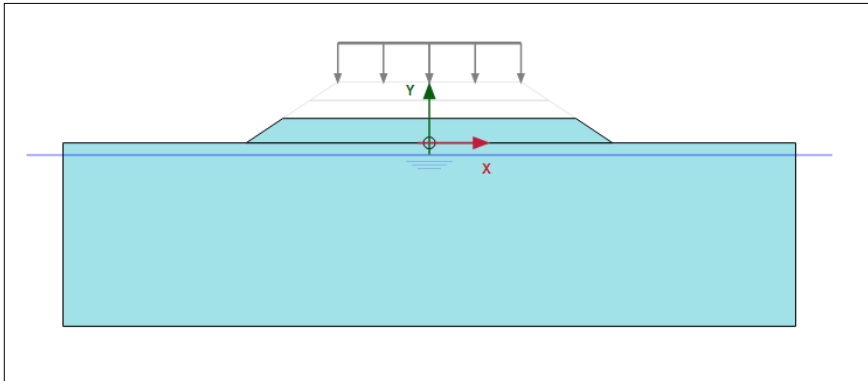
Fase 1, primeros 4 metros de terraplén
